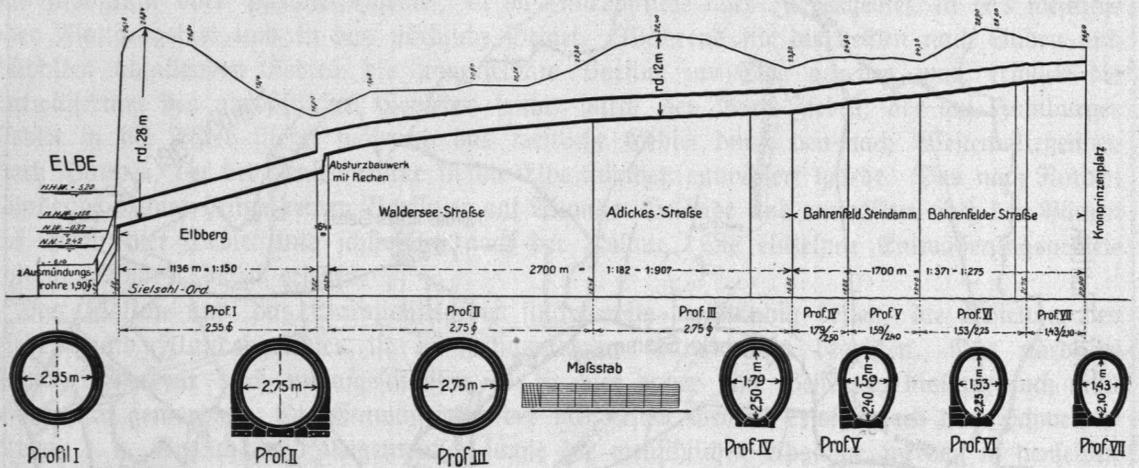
Längenschnitt und Querschnitt des neuen Stammesiefes.
